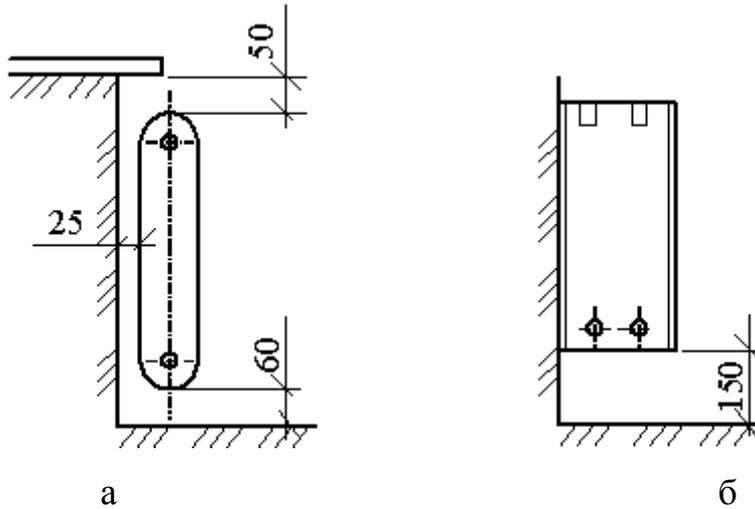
Схемы установки отопительных приборов у пола помещений жилых зданий:
